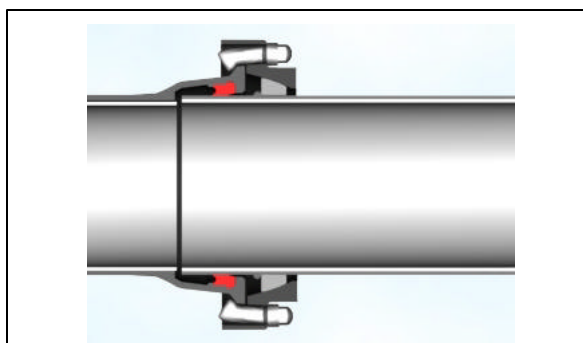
Concluída a montagem, o conjunto deverá apresentar a seguinte configuração.
